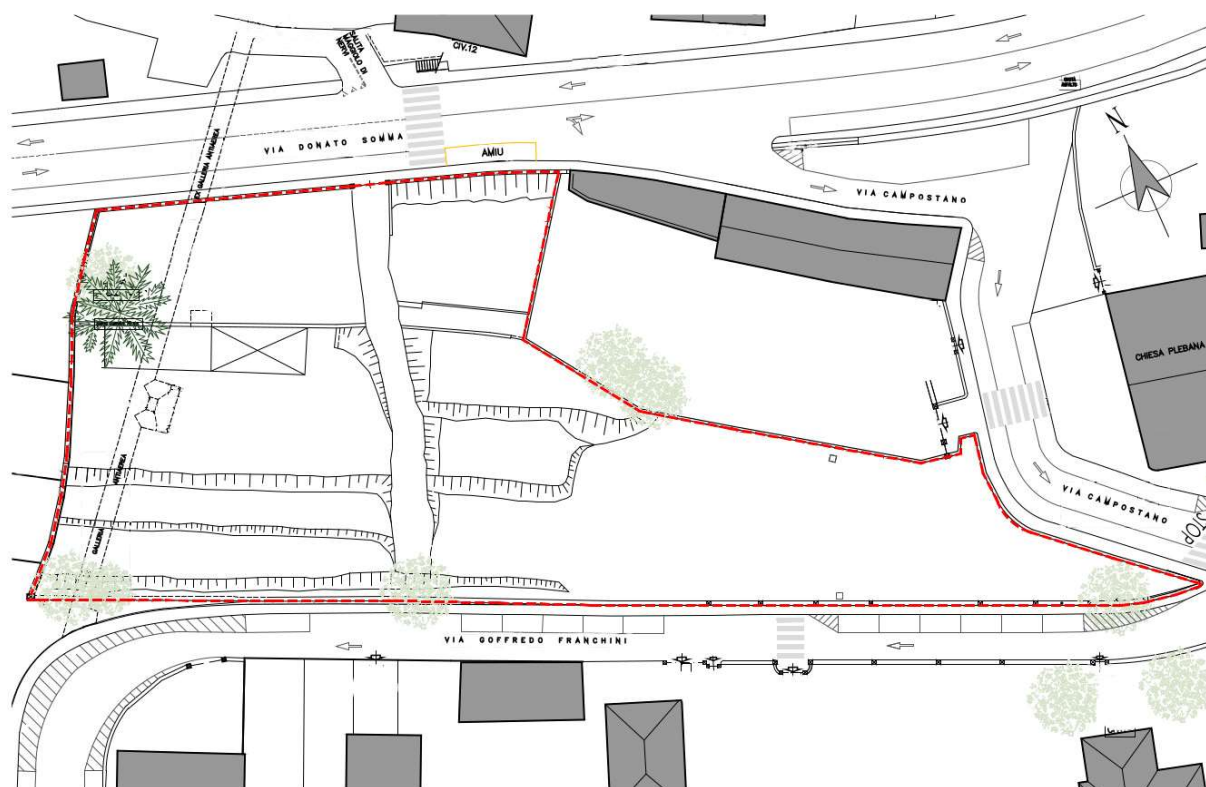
planimetria generale dello stato di fatto, in rosso l'area di intervento.
